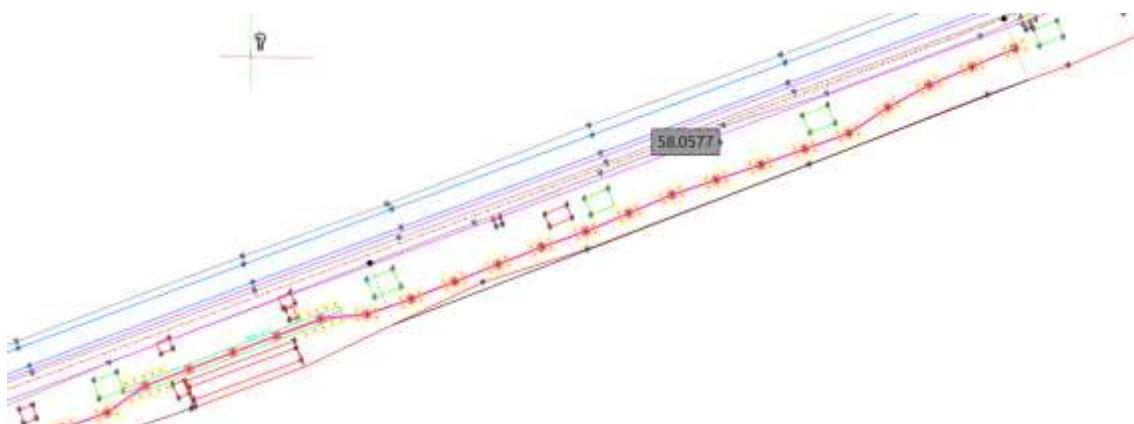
Longitud del tramo 2 de la pantalla R358-376 con interferencia con muro preexistente.
